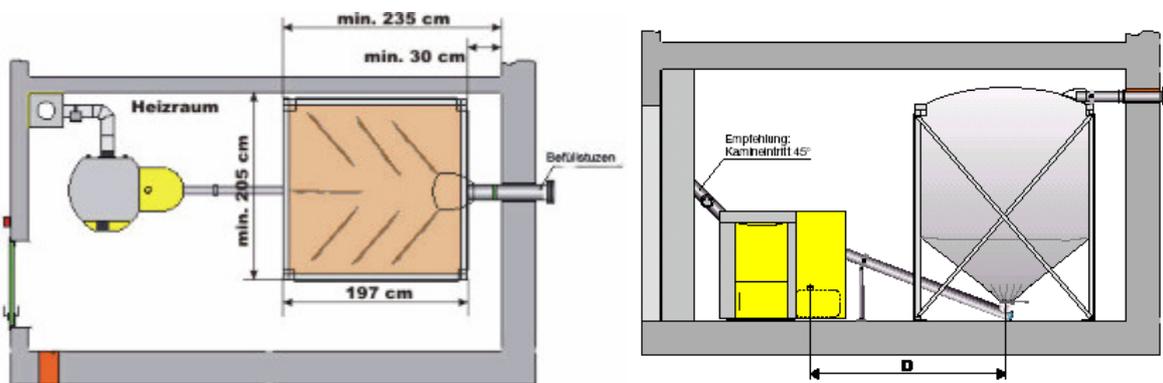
Gewebesilo Holzpellets (Quelle: Soltec)
